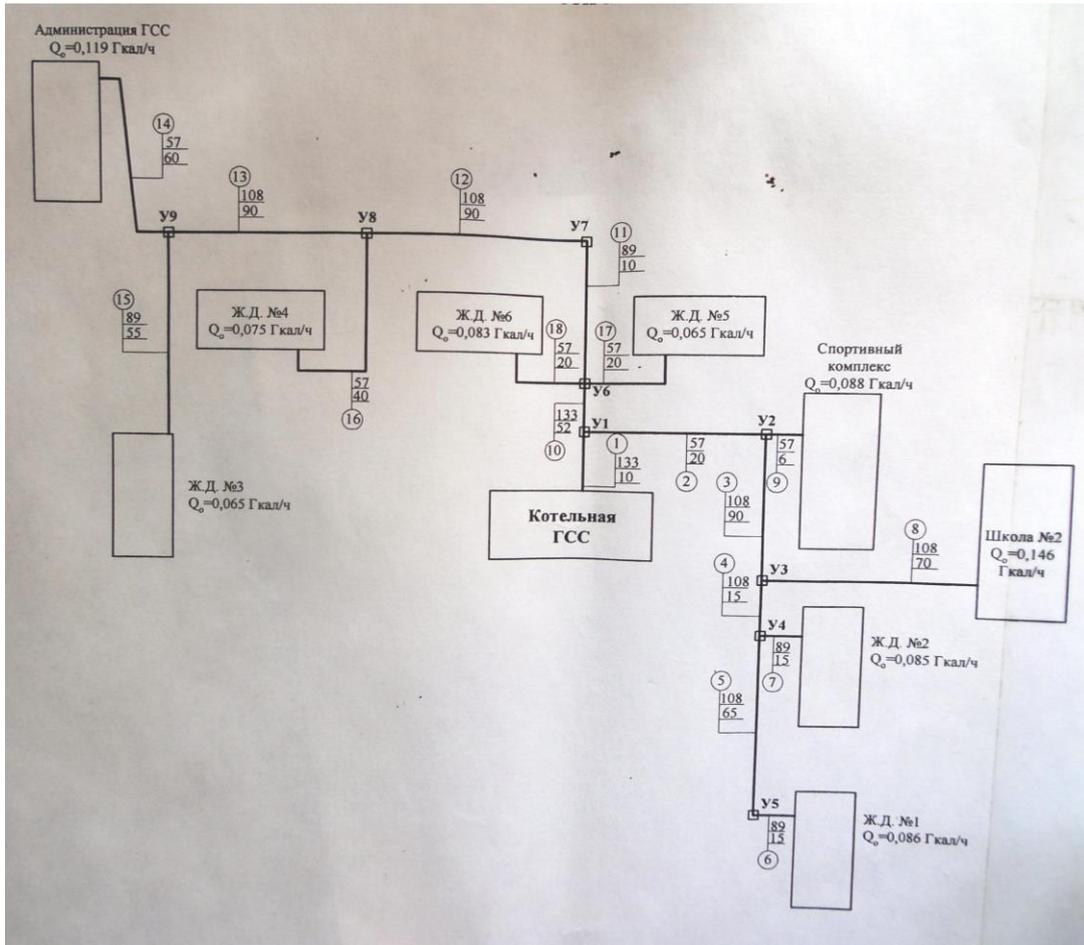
Принципиальная схема тепловых сетей котельной №4
